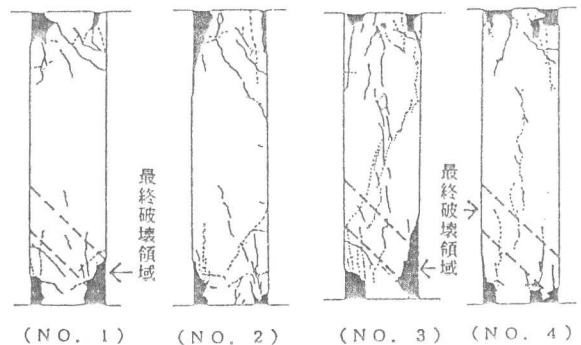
各試験体のひび割れ図(部材角R=1/50)
